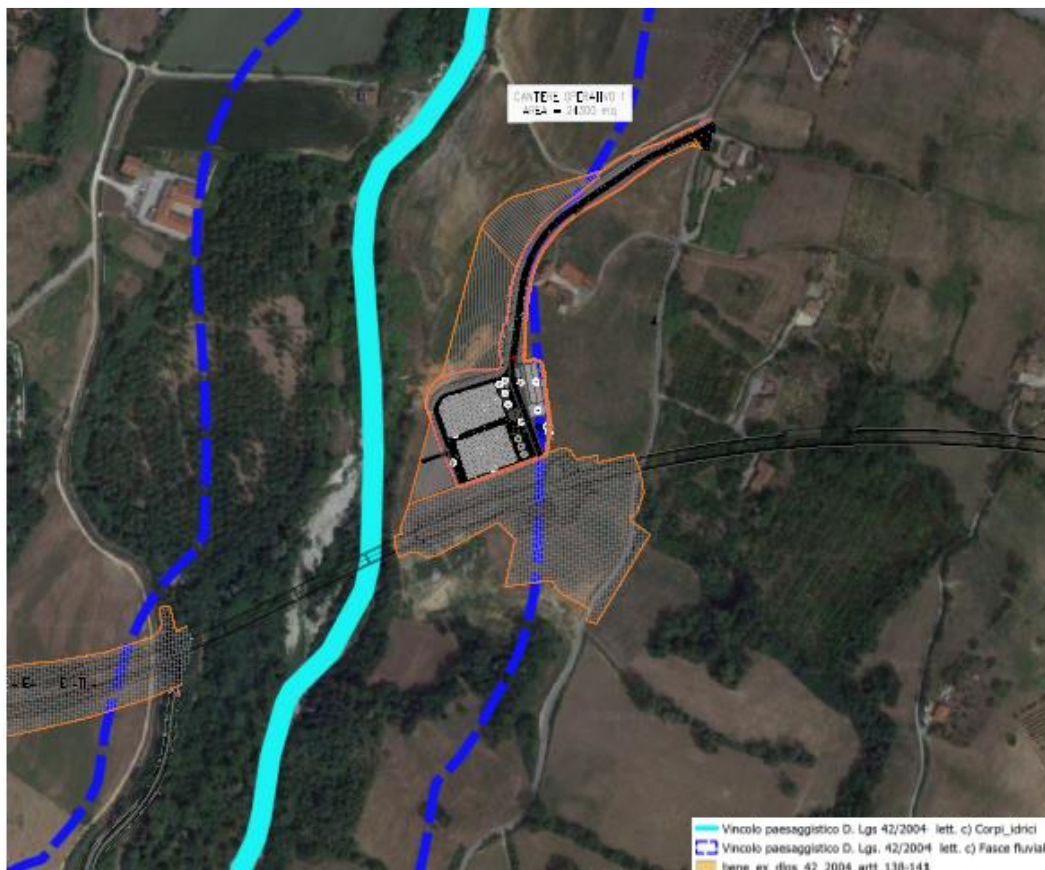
Asse principale - Layout cantiere operativo 1 - Vincoli
